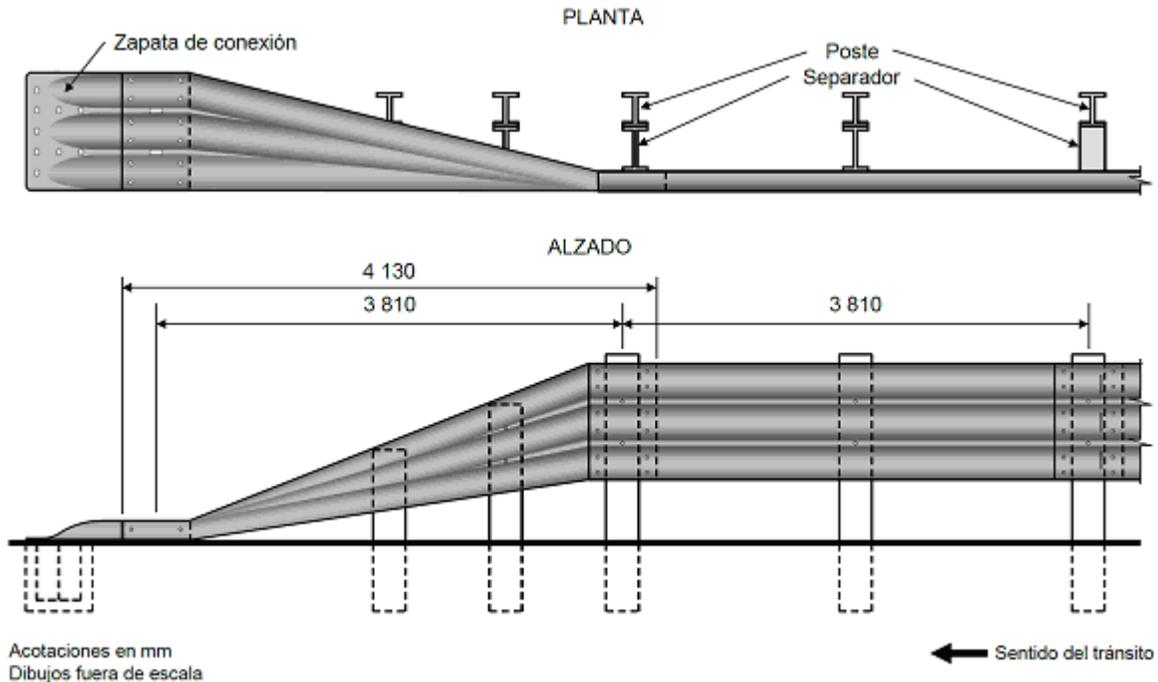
Sección terminal aterrizada para vigas acanaladas de dos y de tres crestas (OD-4.4.2/A)
